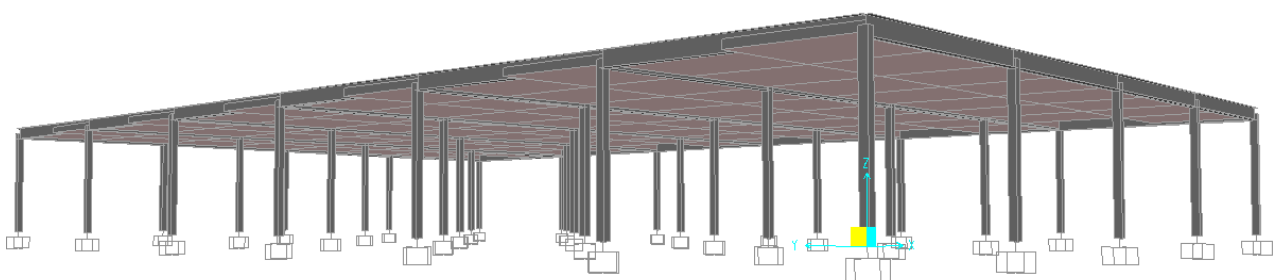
BLOQUE II – VISTA EXTRUIDA INFERIOR
